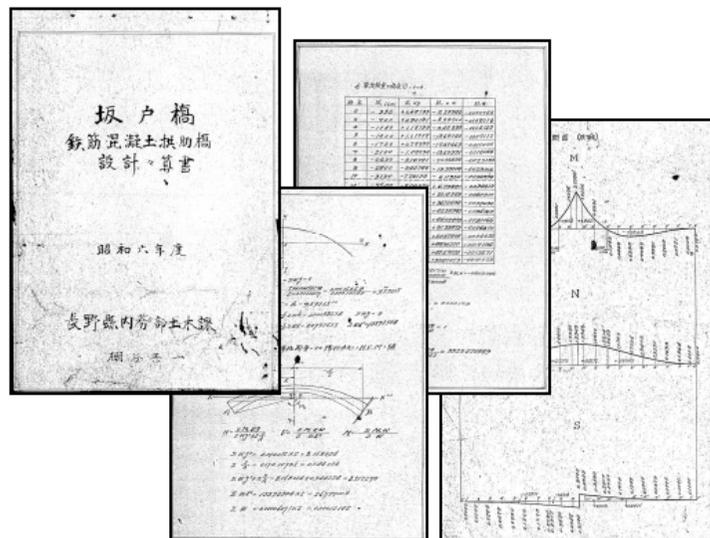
坂戸橋鉄筋混凝土拱助橋設計々算書 抜粋
